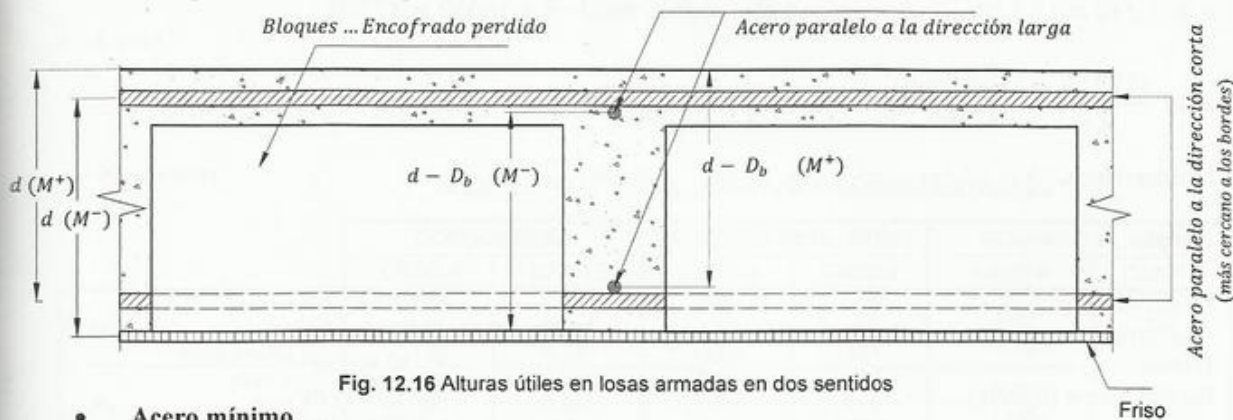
Alturas útiles en losas armadas en dos sentidos
